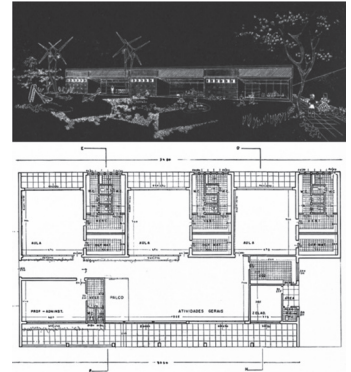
Jardim de Infância Modelo: croquis e planta baixa. Fuente: *Construindo Escolas para o Rio Grande do Sul*, 1954, p. 1-2.
